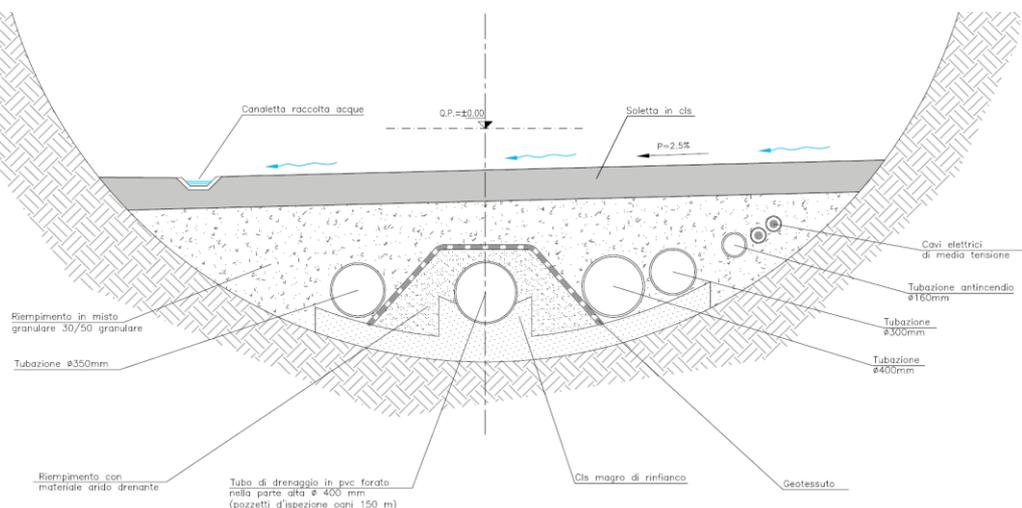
Canaletta per il drenaggio delle acque di piattaforma
